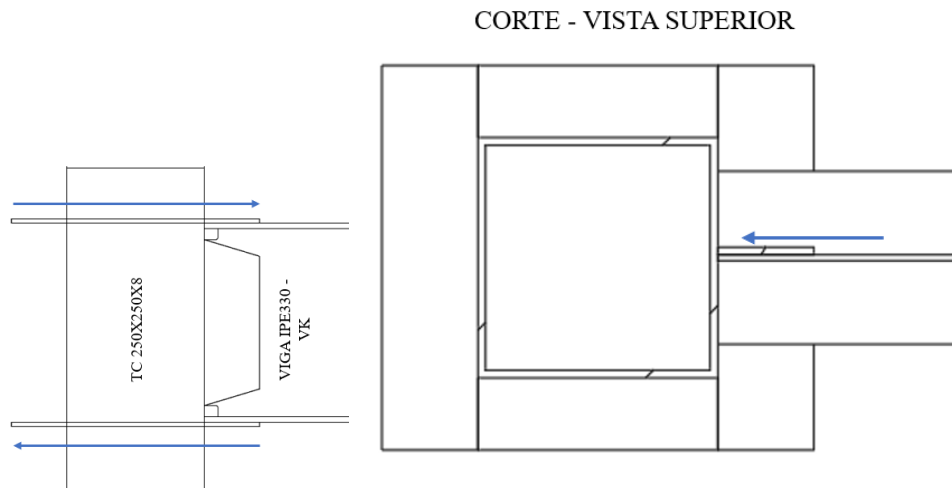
Conexión Columna – Viga IPE 330- VK.
